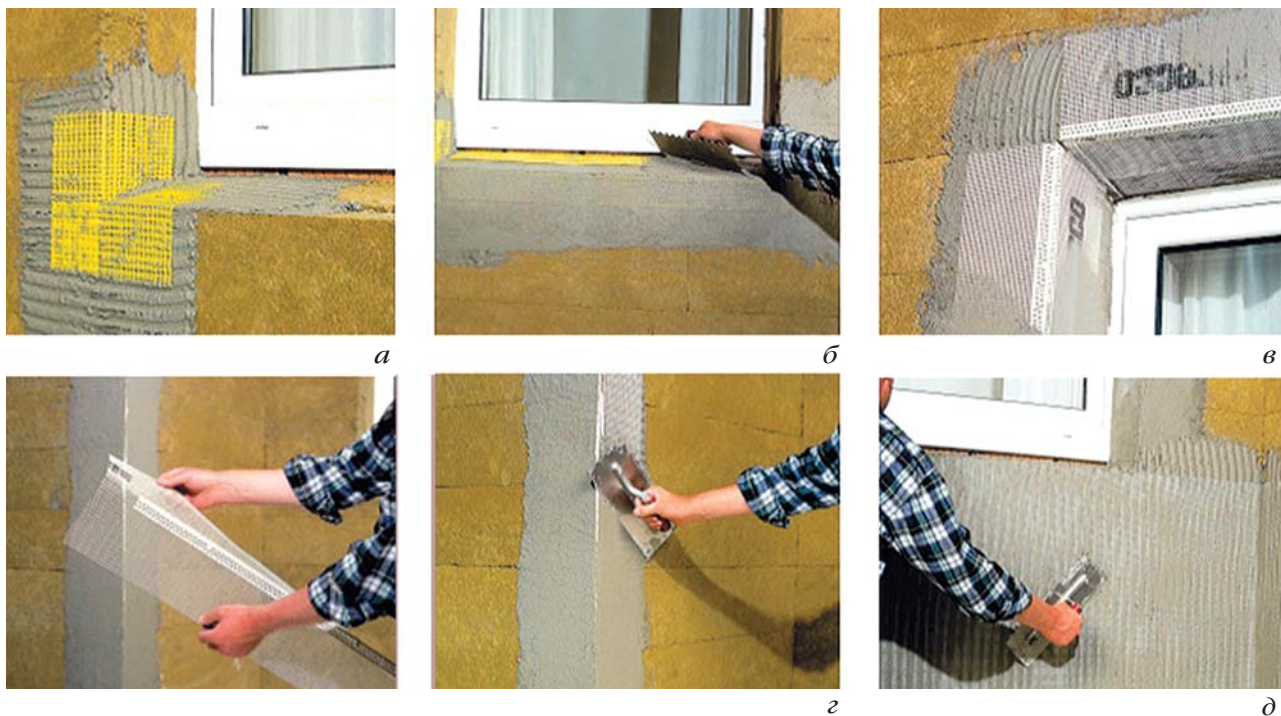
Армирование основания: а — сеткой углов оконных и дверных проемов; б — сеткой откоса; в — уголком и сеткой откосов; г — уголком и сеткой углов стен; д — сплошное армирование
